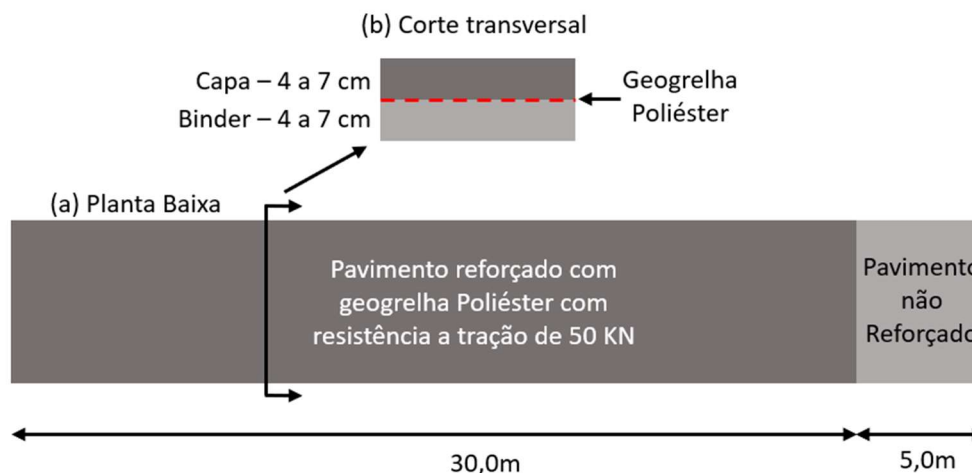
Croqui com dimensões da seção teste construída por Damisch e Kirschner (1994): a) planta da seção teste; b) corte transversal da seção teste. Fonte: elaborado pelo autor (2024).
